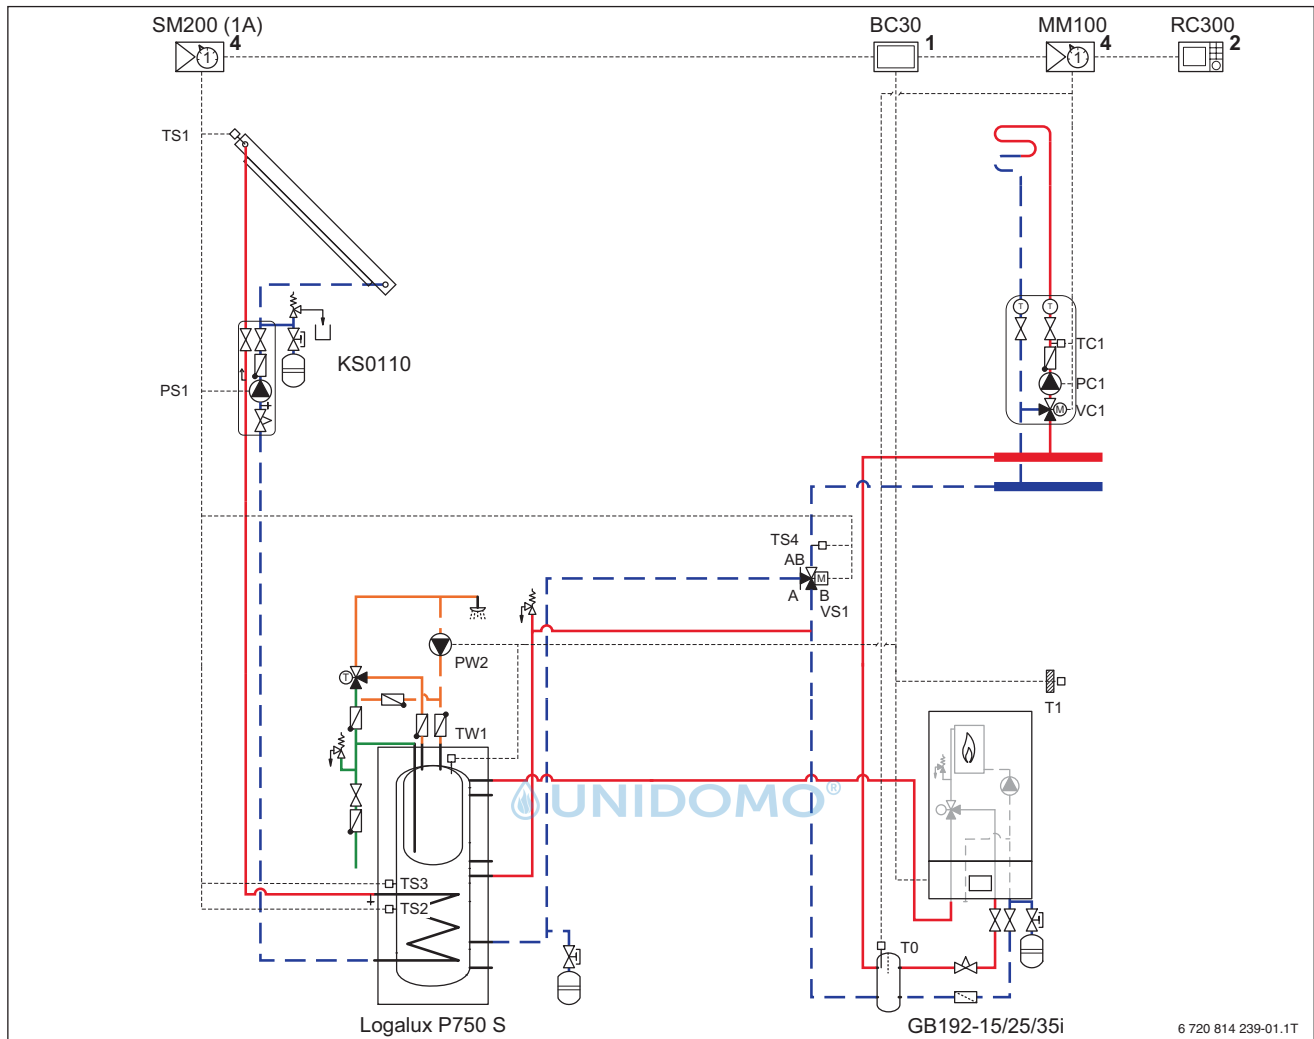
Anlagenschema mit Regelung (unverbindliche Prinzipdarstellung)
